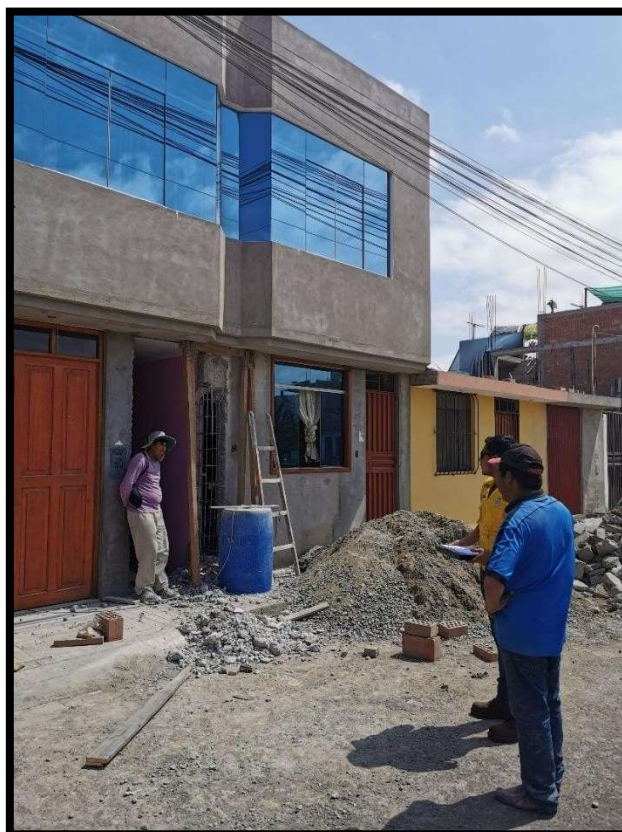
Encuesta a propietario de construcción de Vivienda unifamiliar.
